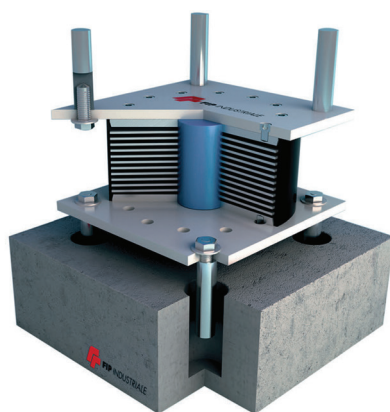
Схематический вид свинцово-резиновой опоры
